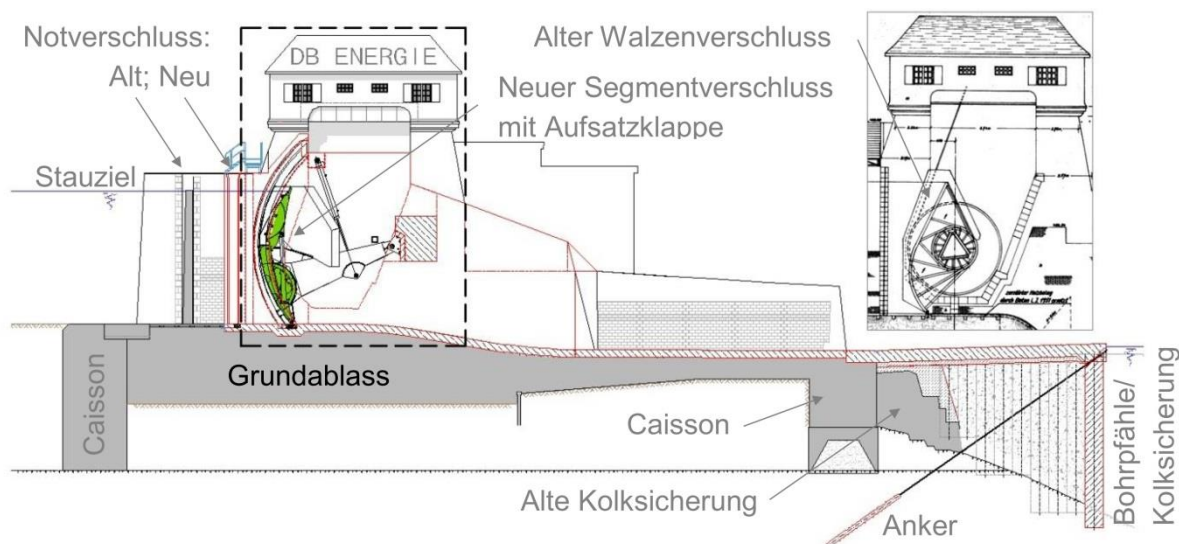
Querschnitt Grundablass mit neuem Drucksegment und Aufsatzklappe
